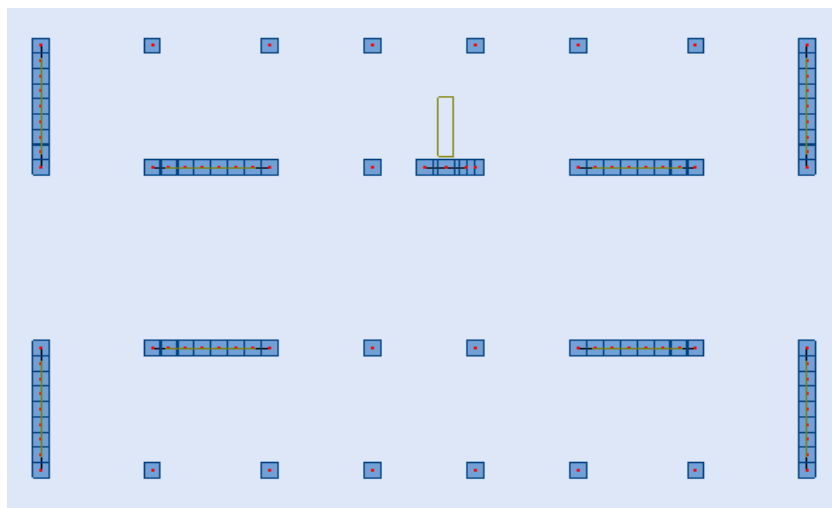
La 1^{ère} disposition des murs voiles et poteaux
